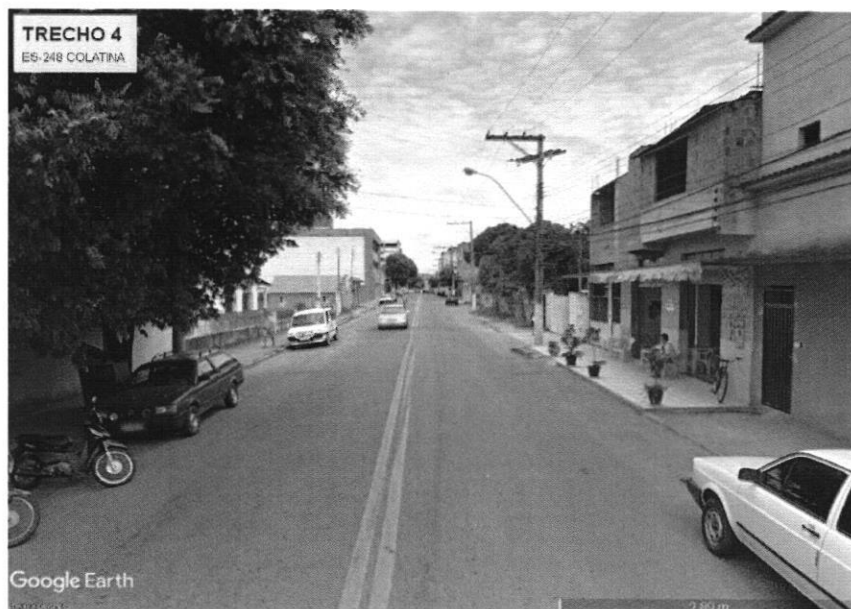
FOTO MOSTRANDO CONSTRUÇÕES, ILUMINAÇÃO PÚBLICA E CALÇADAS
